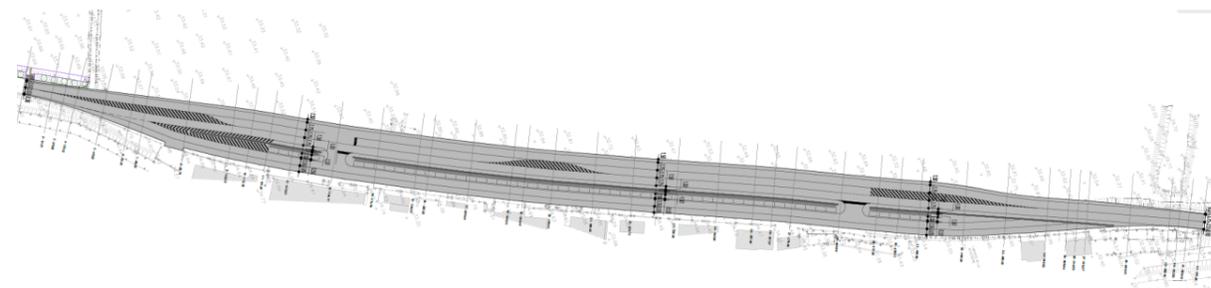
planimetria di progetto variante SS64 Porrettana in località Case Nuove³¹
